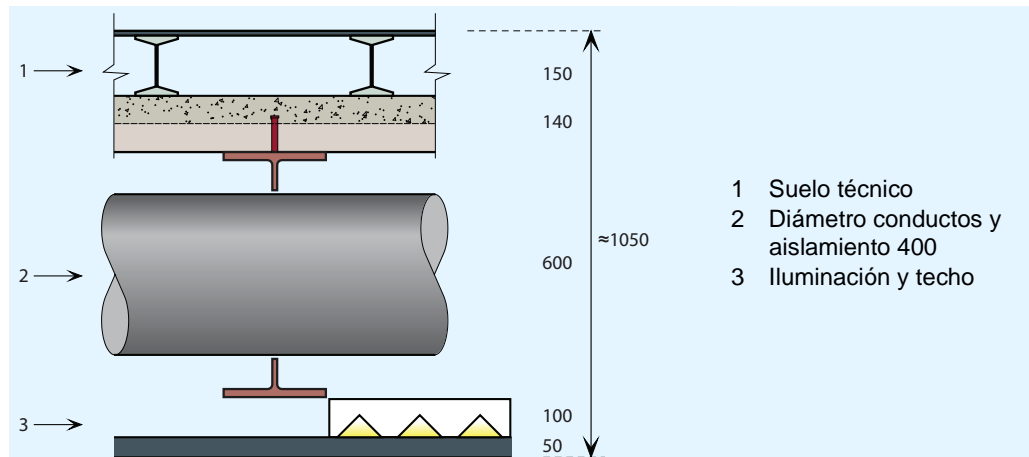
Viga celular – sección transversal con integración de instalaciones
